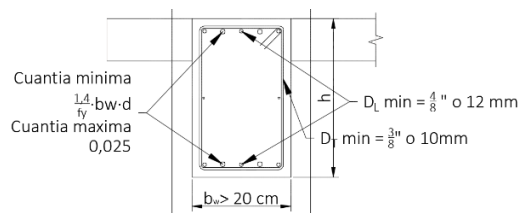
Detalle transversal estructural de VIGA para ductilidad DMO
